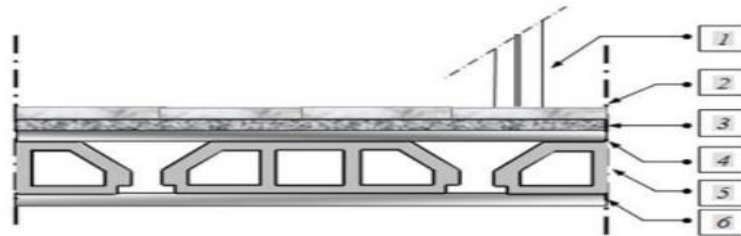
Coupe verticale de plancher courant à corps creux.
